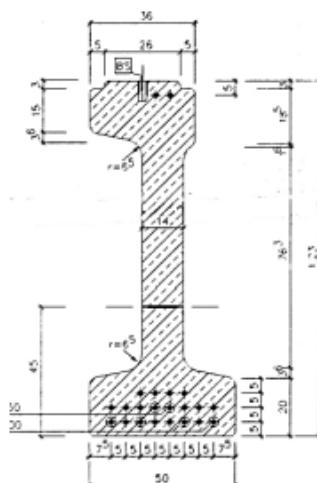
4: Secção transversal da viga longitudinal tipo (dimensões em cm) com representação dos cabos de pré-esforço (S.A., 2000)
